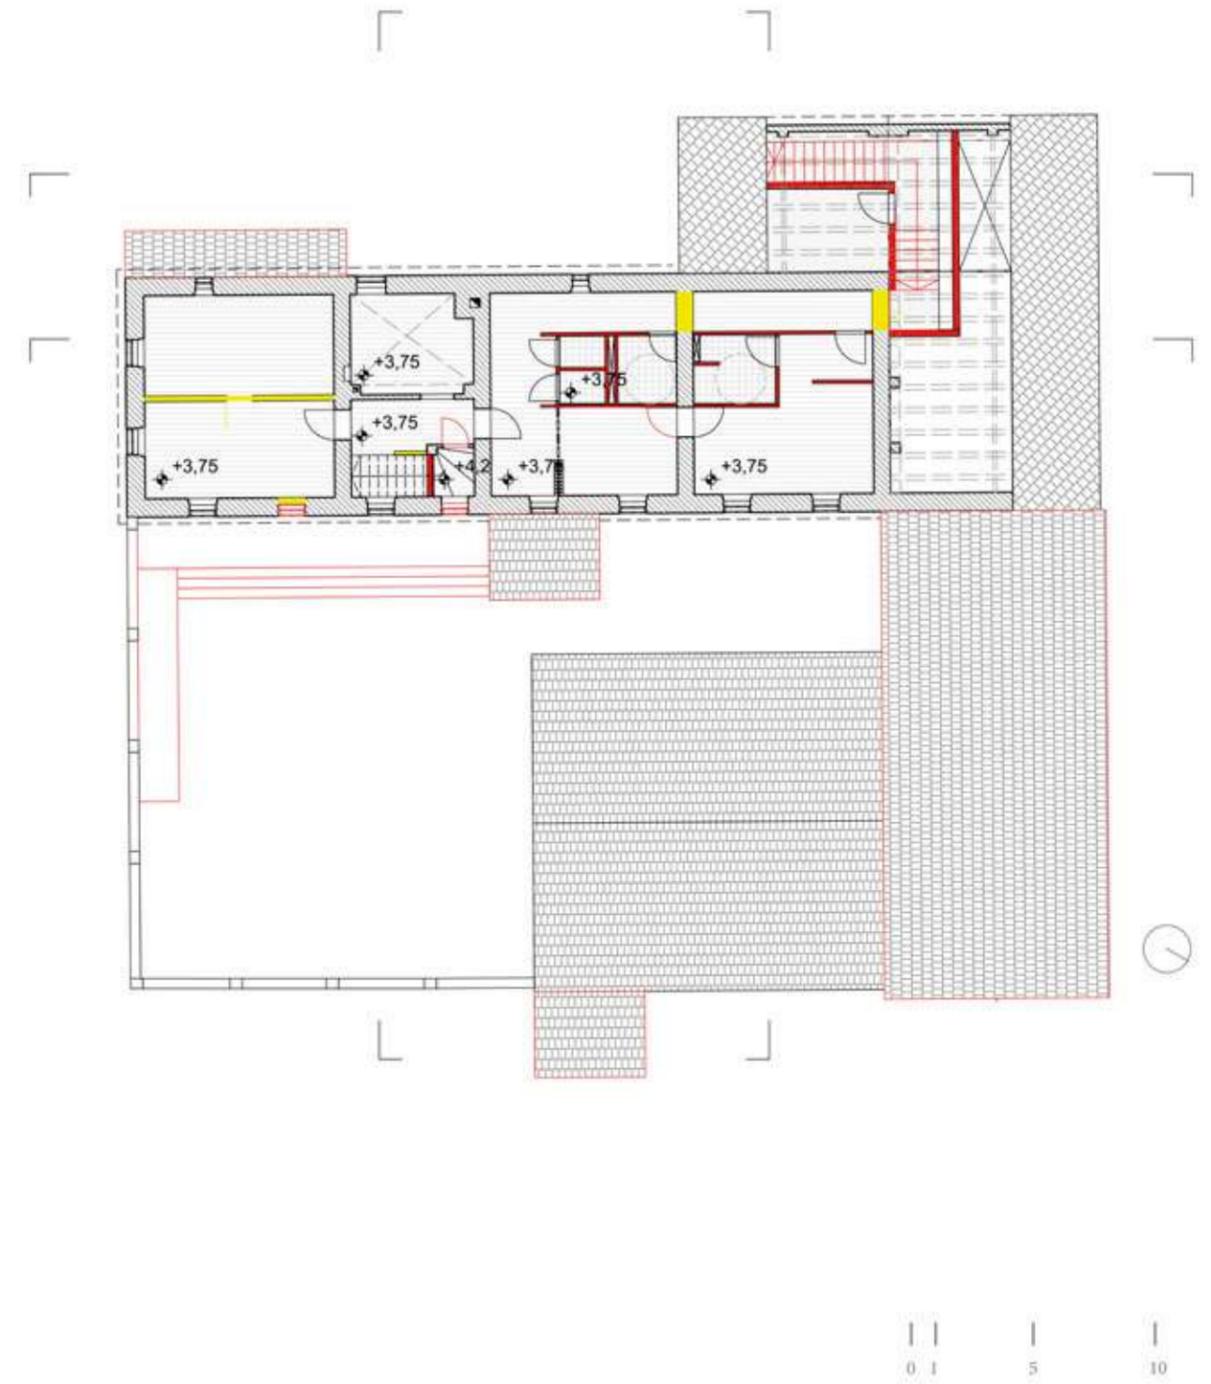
Grundriss Obergeschoss, M 1:200
